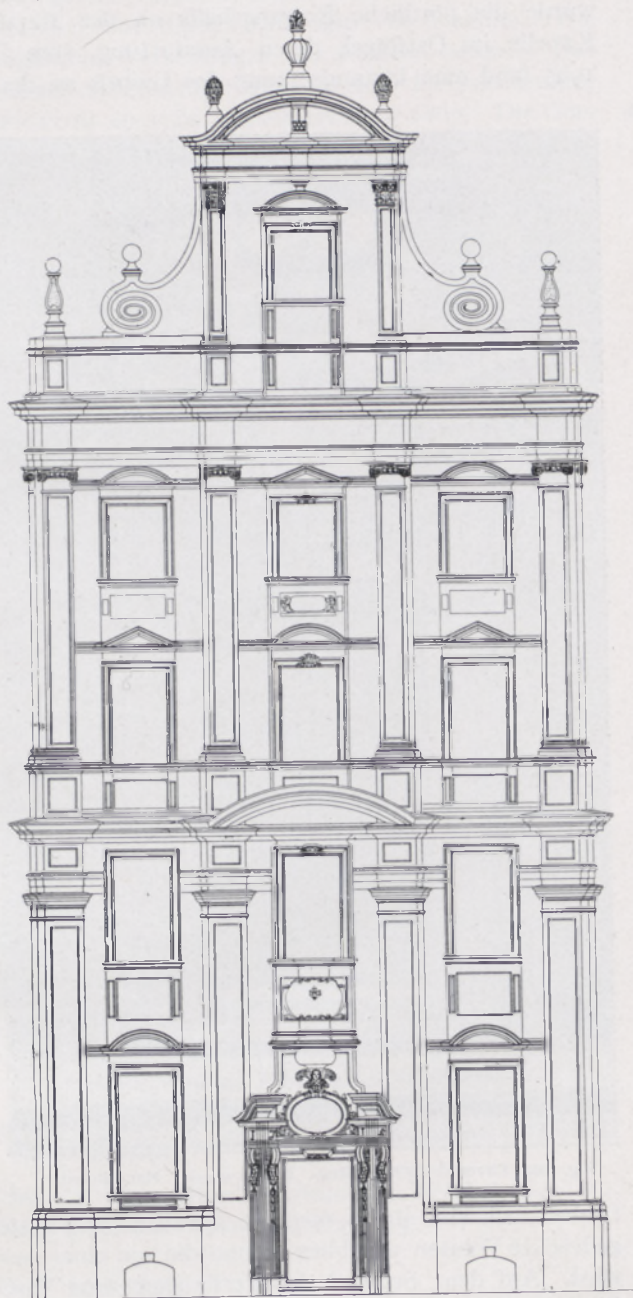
Ehem. Jesuitenkolleg. Fassade a. d. Marzellenstr.
